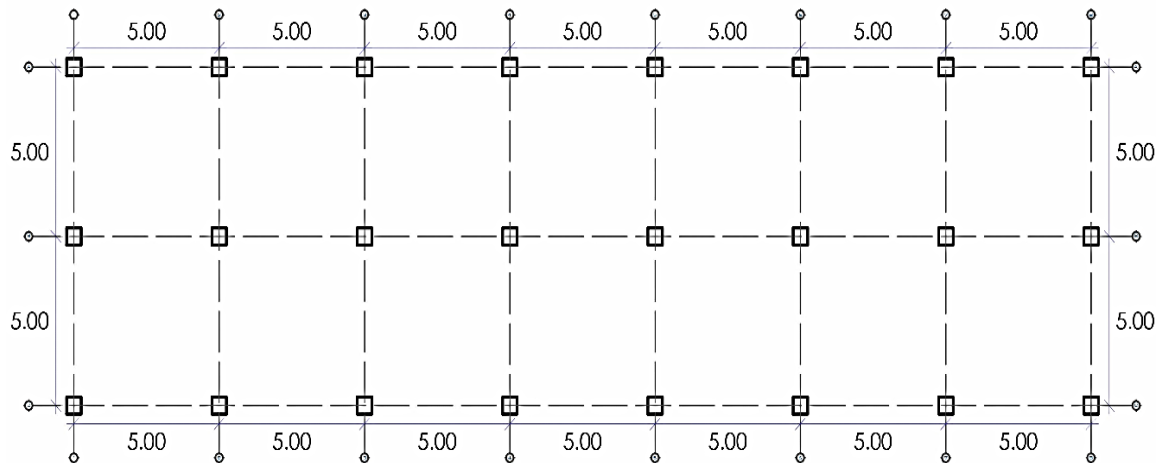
Estructuración de Losa Aligerada -Sistema estructural tradicional.
